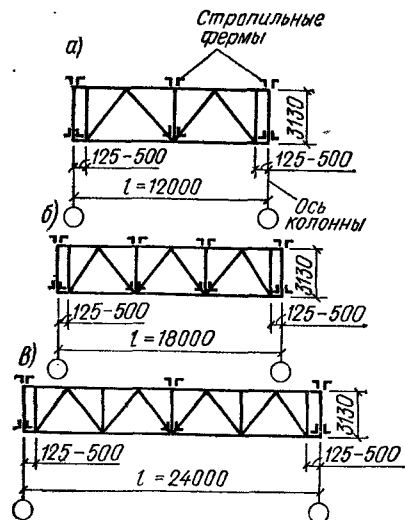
Унифицированные типовые схемы (а—в) подстропильных ферм
